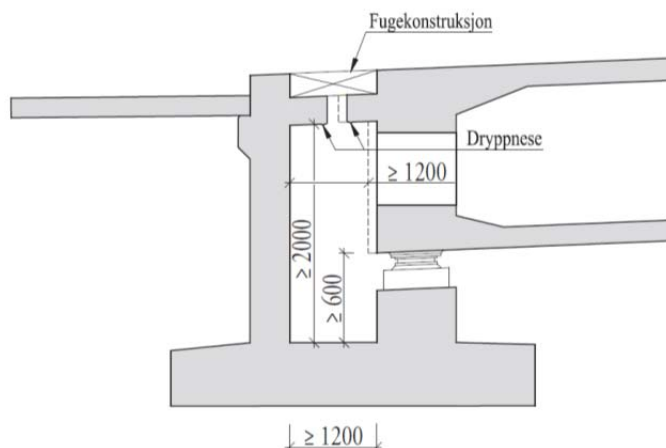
Krav til frihøyde ved lagre – 2-sidig tilkomst/fast eller bevegelig lager
